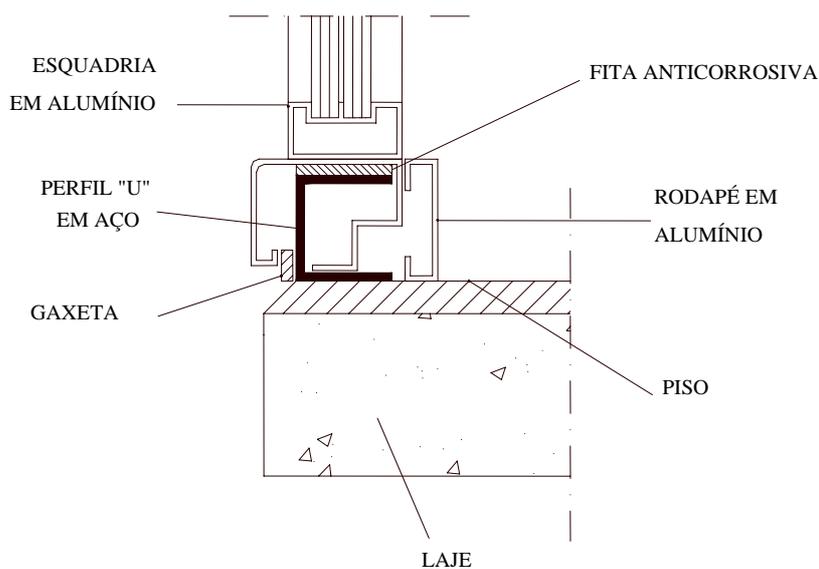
Seção 2-2: Detalhe da fixação do caixilho na laje.
